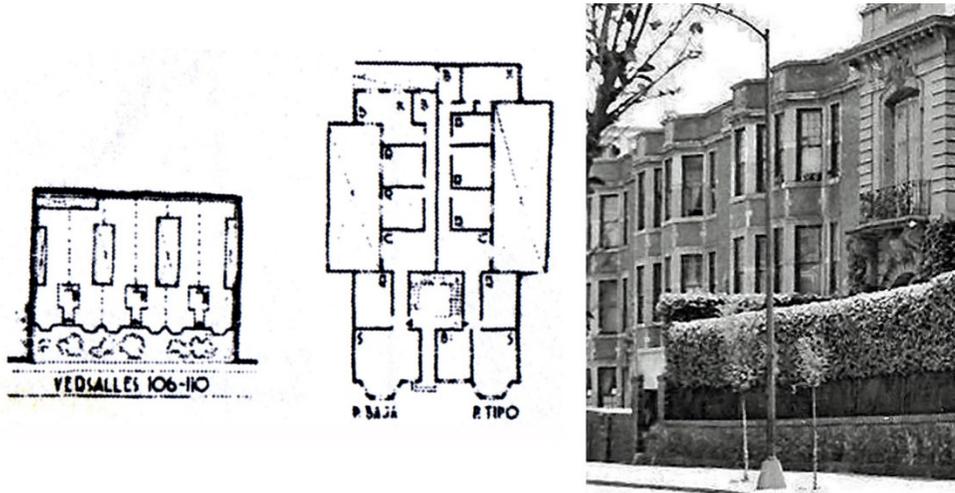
Vista de la fachada del edificio ubicado en Versalles núm. 106-110, ca. 1970. La fachada del edificio aun existe aun, pero se encuentra completamente tranformada, inclusive con un nivel menos.
